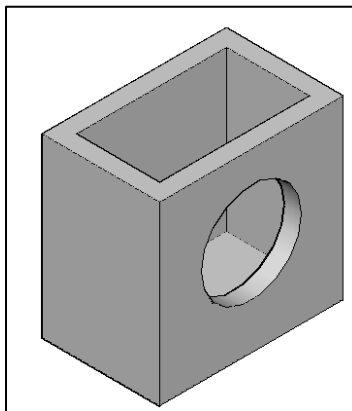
Estructura tipo cajón para la entrada a una alcantarilla.
